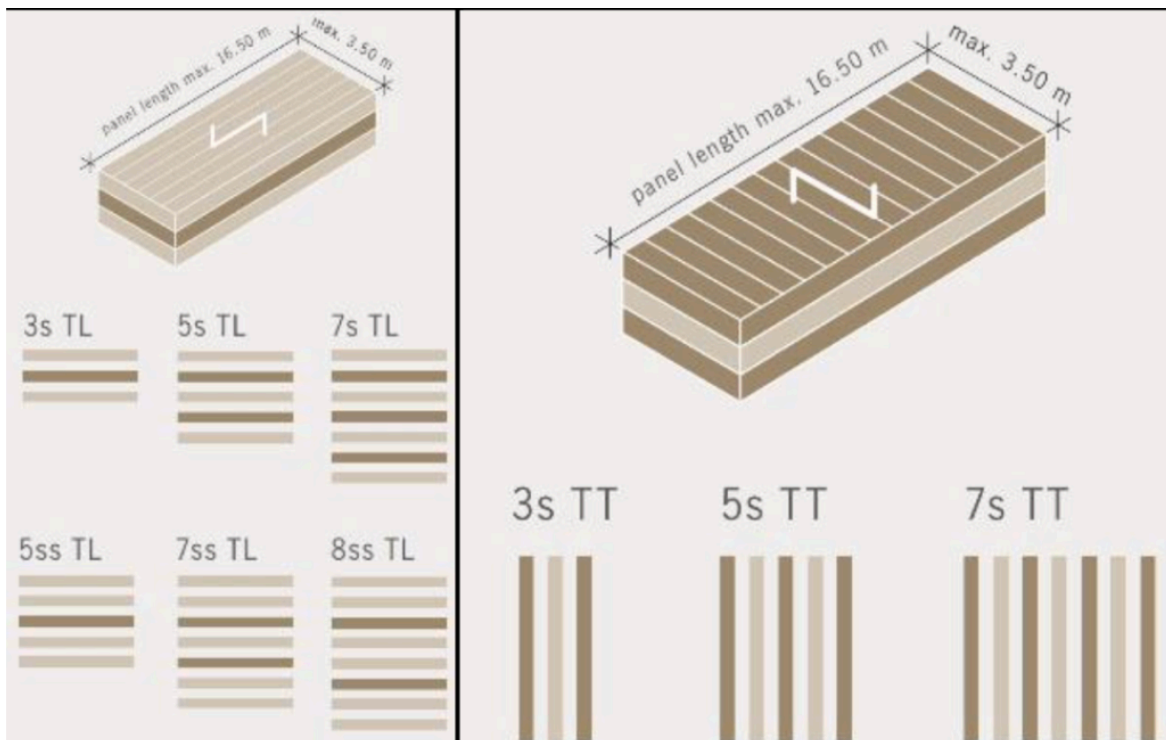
Configuração dos painéis da empresa KLH Massivholz.
